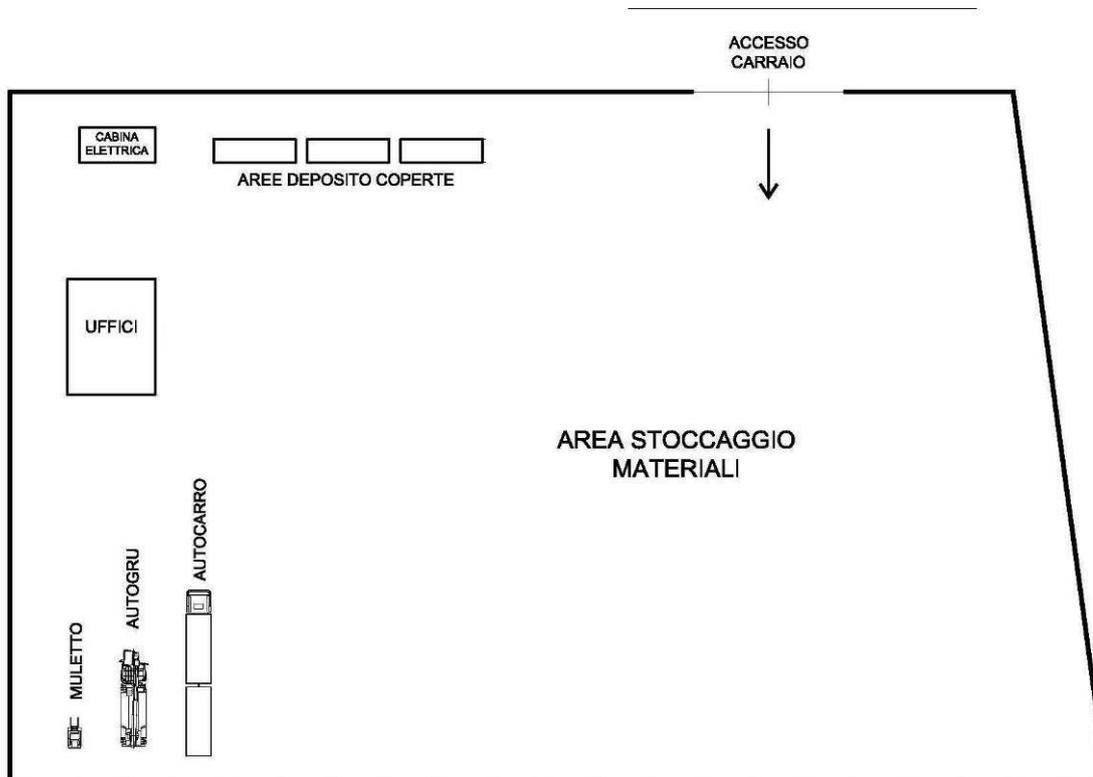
Planimetria dell'area centrale di cantiere - misure indicative
